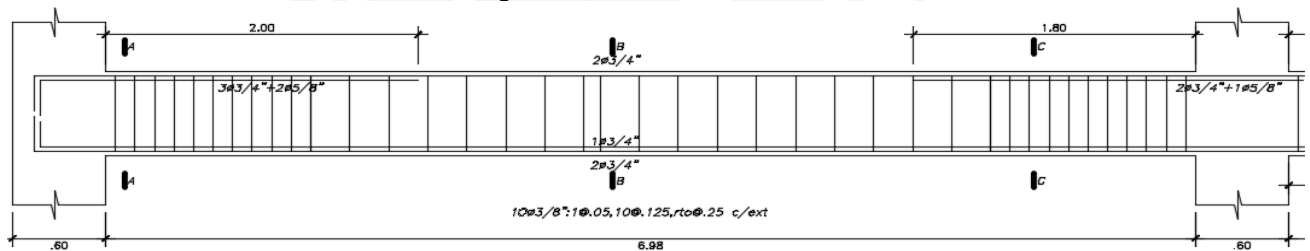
Diseño final viga V-102 (primer tramo)
